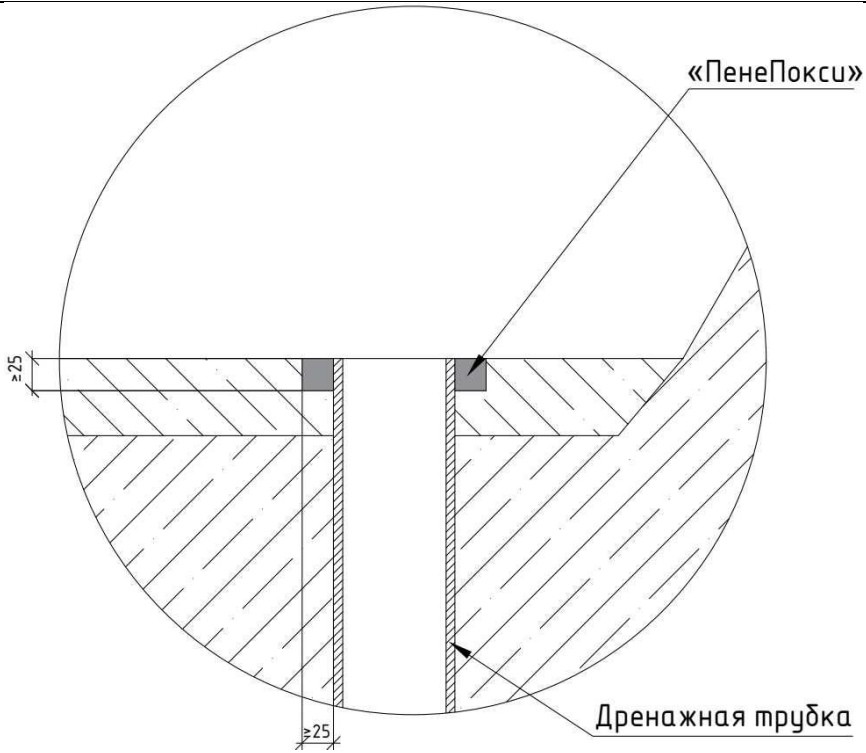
Схема гидроизоляции дренажной трубки
